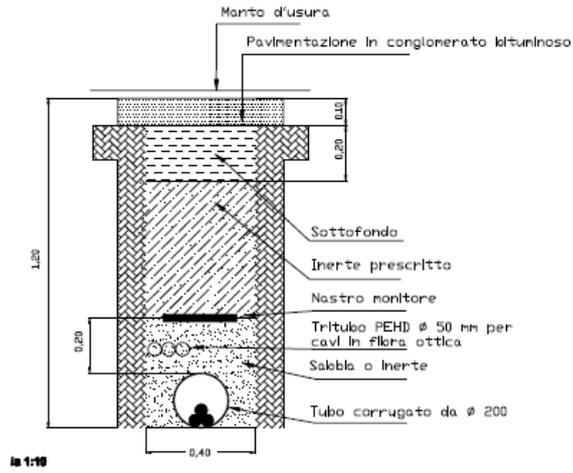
Sezione su strada asfaltata - posa di n°1 cavo MT
